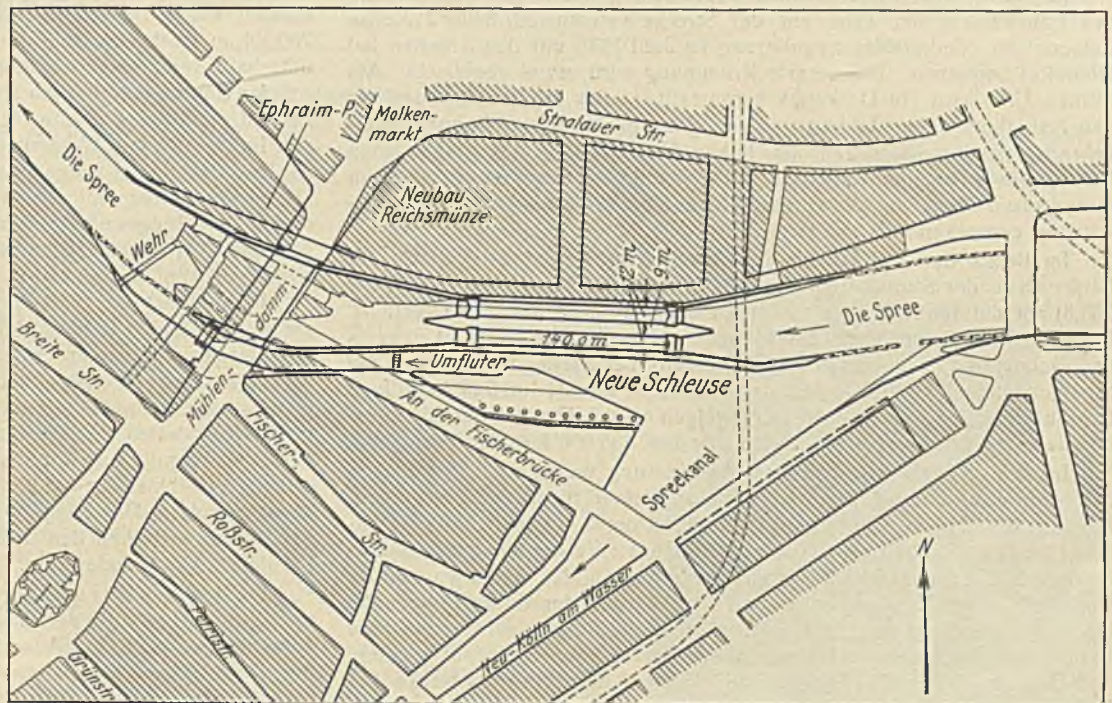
Lageplan der neuen Mühlendammsschleusen.
